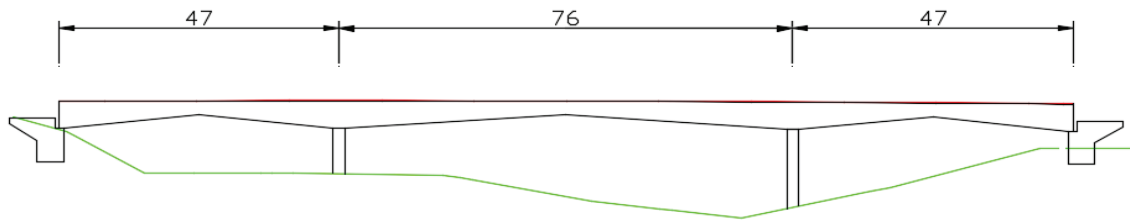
La coupe longitudinale de la variante Ponts en béton précontraint construits par encorbellements successifs.
